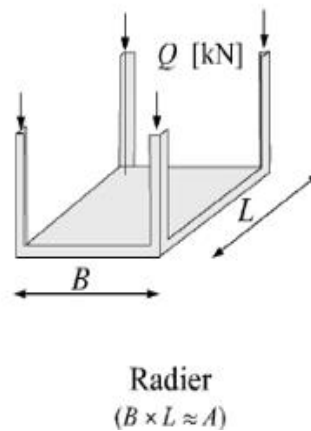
Semelles en radier (Saadaoui et Saidia, 2018).
